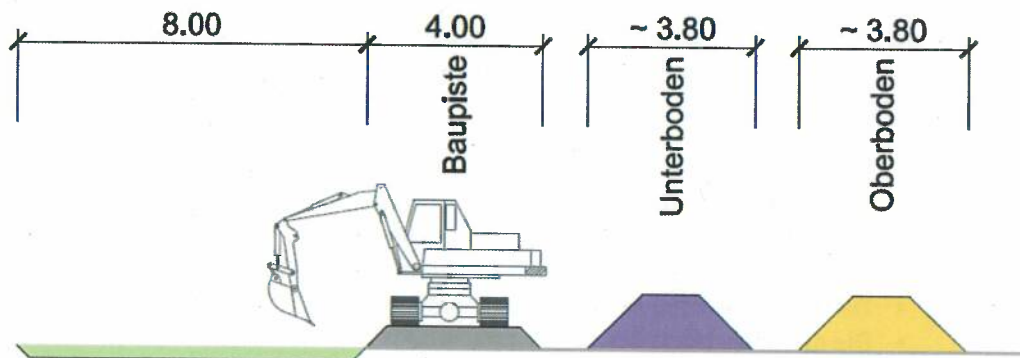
Auszug aus dem Bauphasenplan, Querprofil 2.
